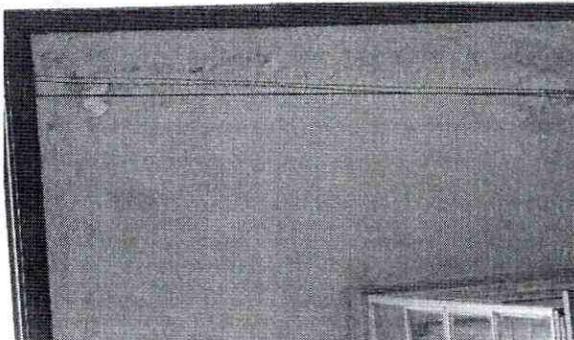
Estado actual de la cubierta en voladizo del tercer piso hacia la parte sur occidental de la edificación.
